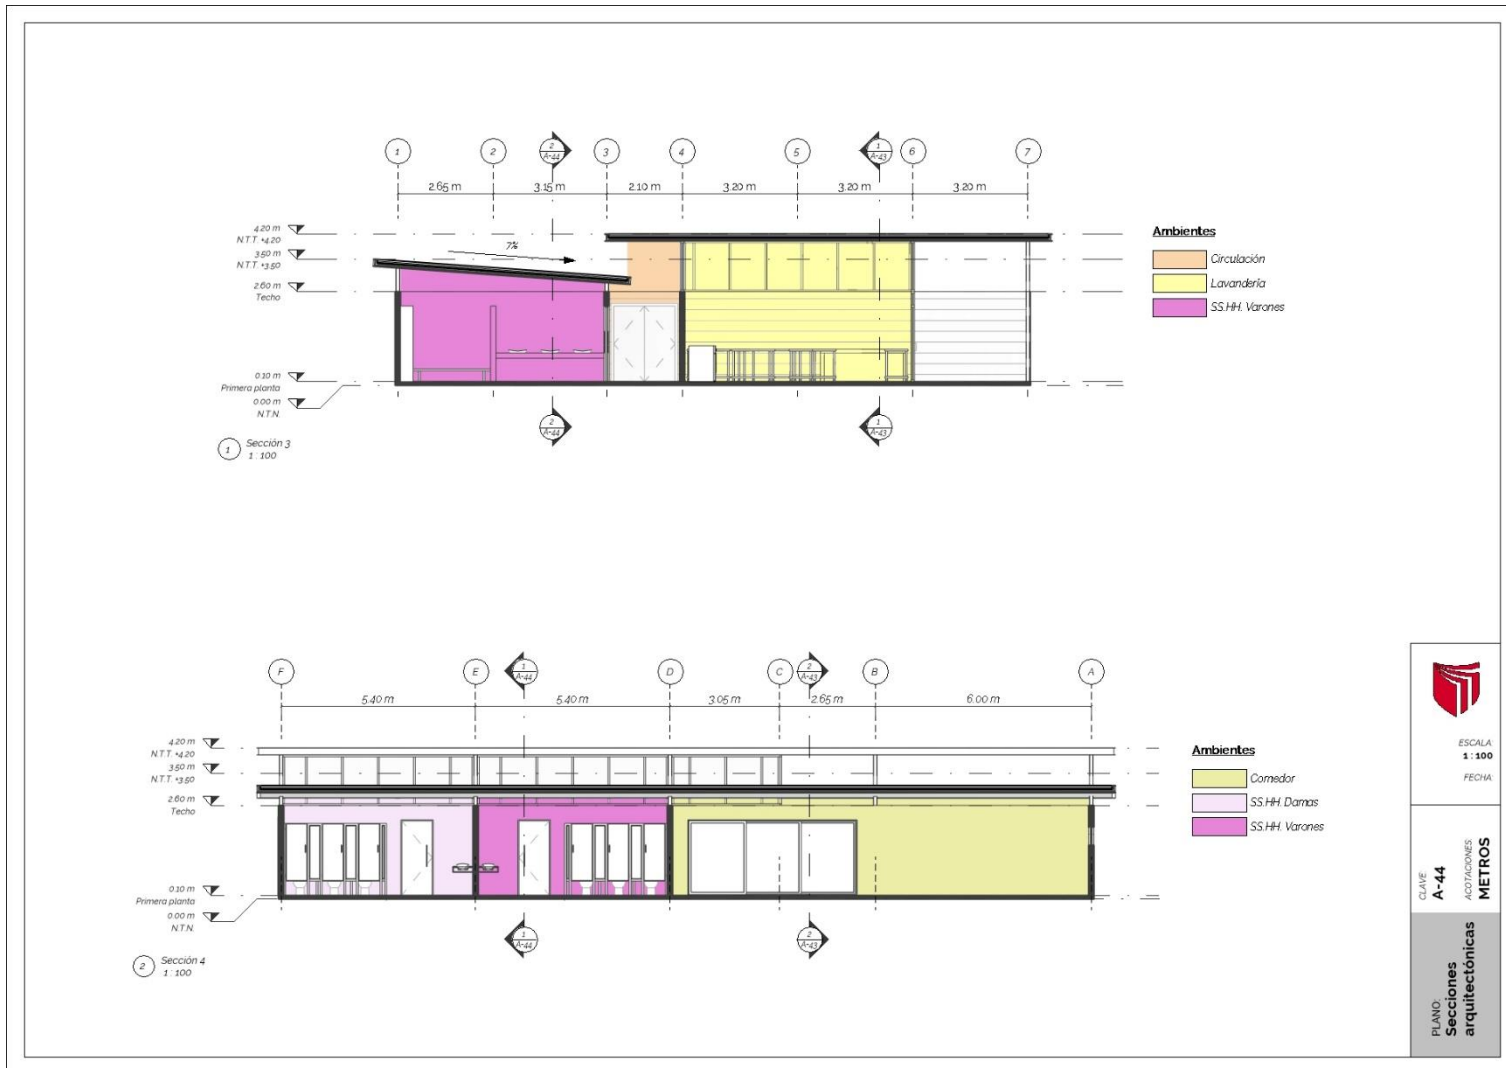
Secciones arquitectónicas serv. hospedaje 02
